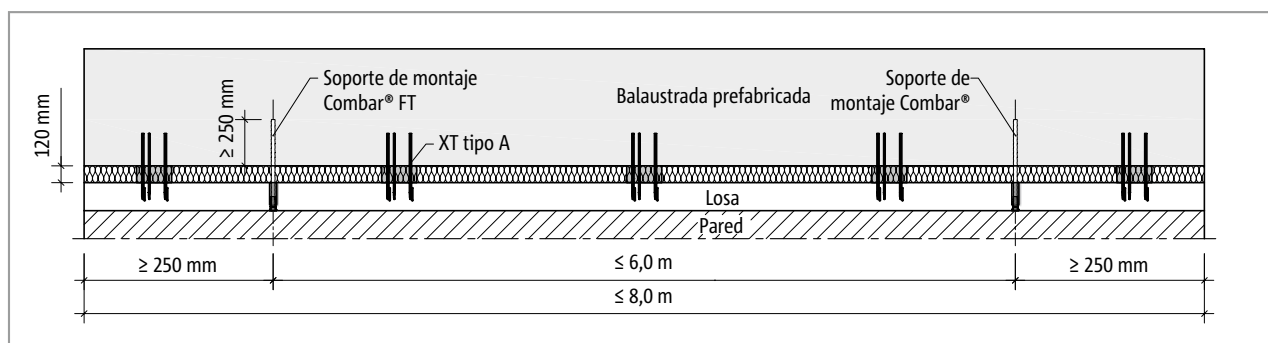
Schöck Isokorb® XT tipo A con soporte de montaje Combar® FT: Distancias al borde y longitud mínima de integración en la balaustrada prefabricada
